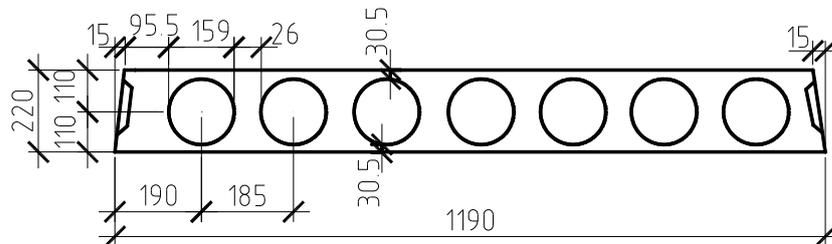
Опалубне креслення плити перекриття п поперечному розрізі
